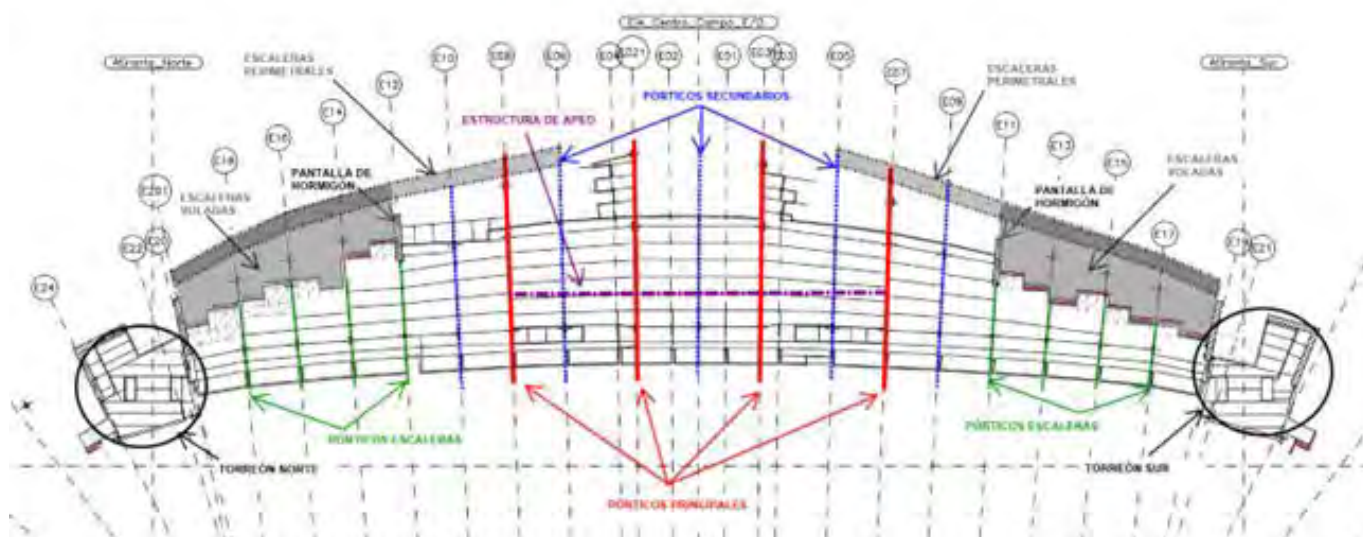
Planta con distribución de pórticos y elementos principales del edificio este.
